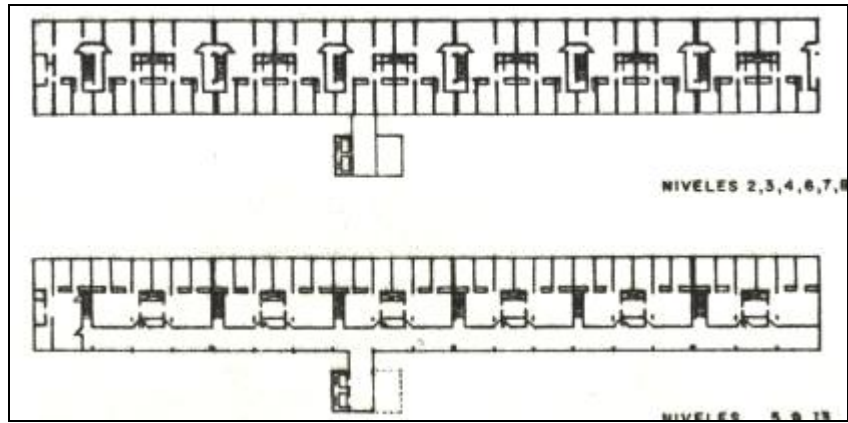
d. Superbloque DL Modificado (1956). Plantas Tipo
